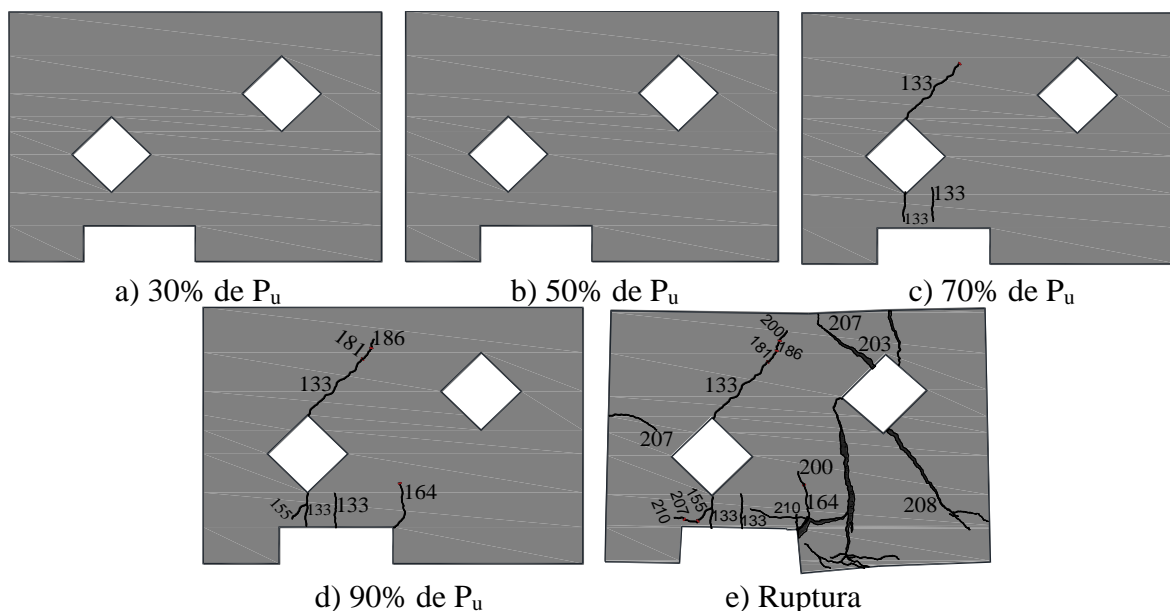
Mapa de fissuração DB1-H2-U-1 (força indicada em kN)
